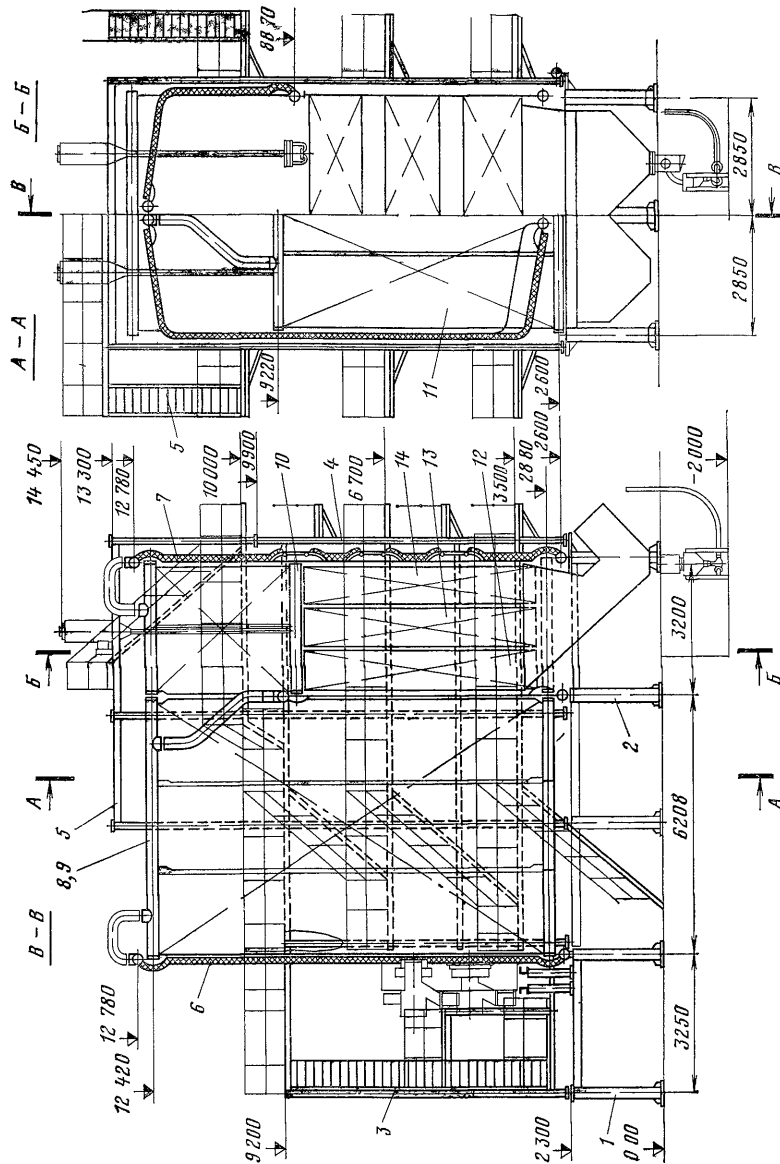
Схема разбивки котла КВ-ГМ-100 на монтажные блоки.
